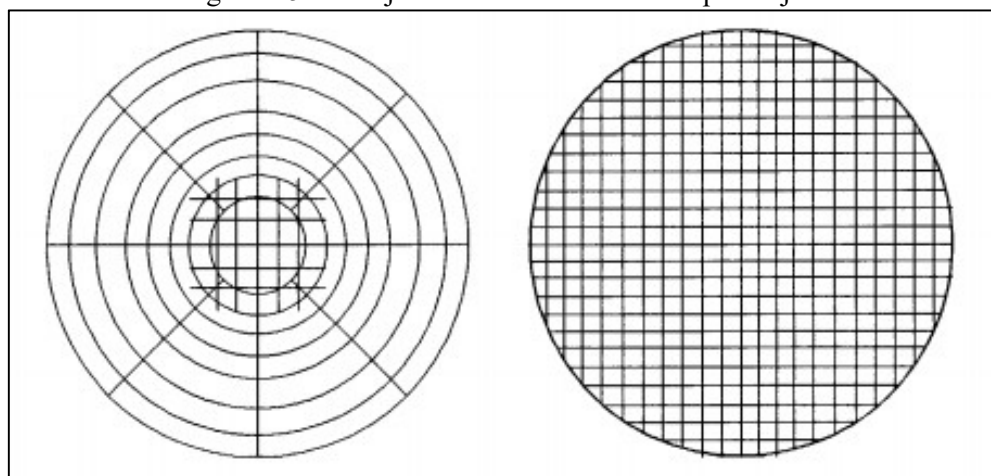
Arranjo adequado para armaduras positivas de lajes circulares.
